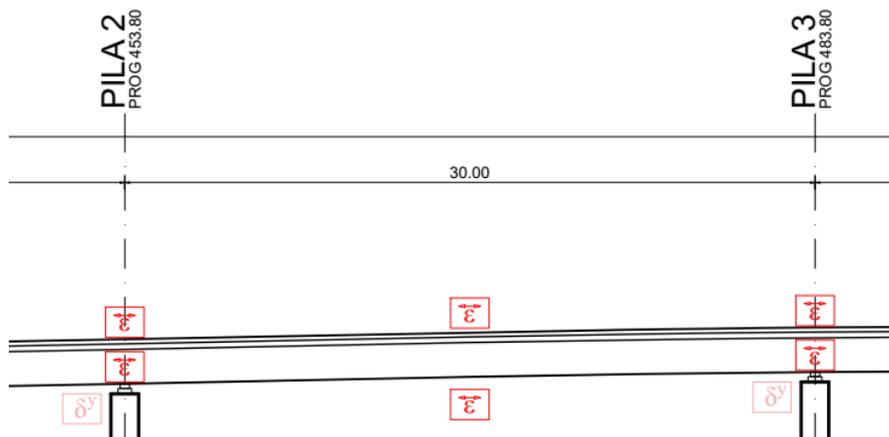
Ubicazione sensori su impalcato (sezione longitudinale campata tipo viadotto MdP)
